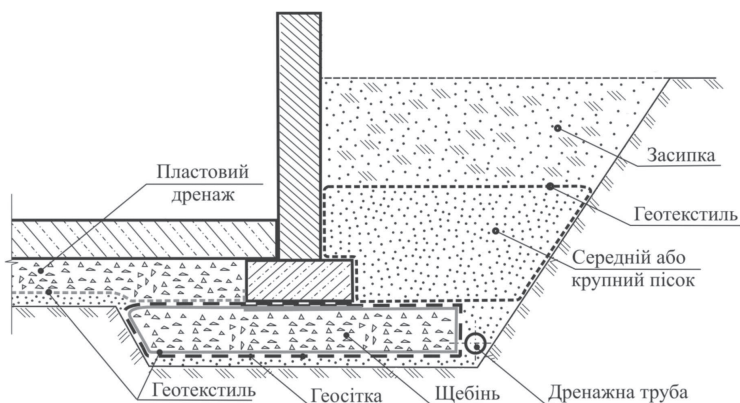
Конструкція прямокутного стрічкового фундаменту з геормованою фундаментною подушкою, яка поєднана з пластовим дренажем
